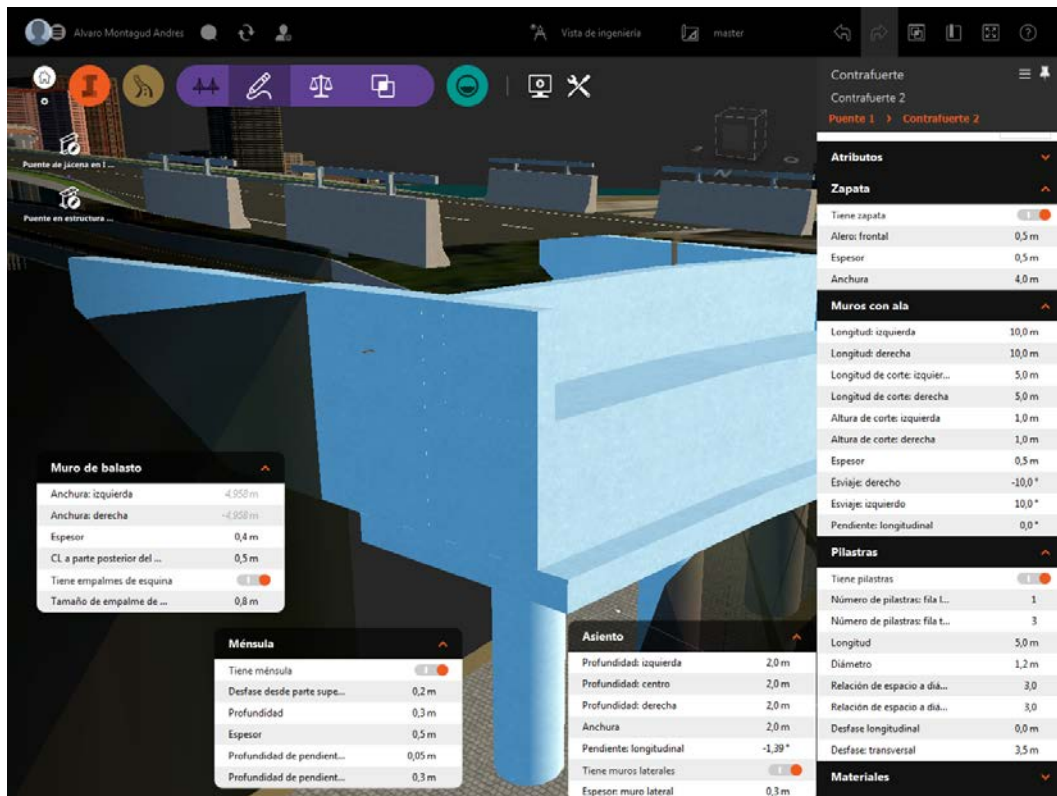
Resultado del estribo abierto con aletas a 10° y cimentación de zapata y pilotes. Fuente: (Infraworks, 2018).
